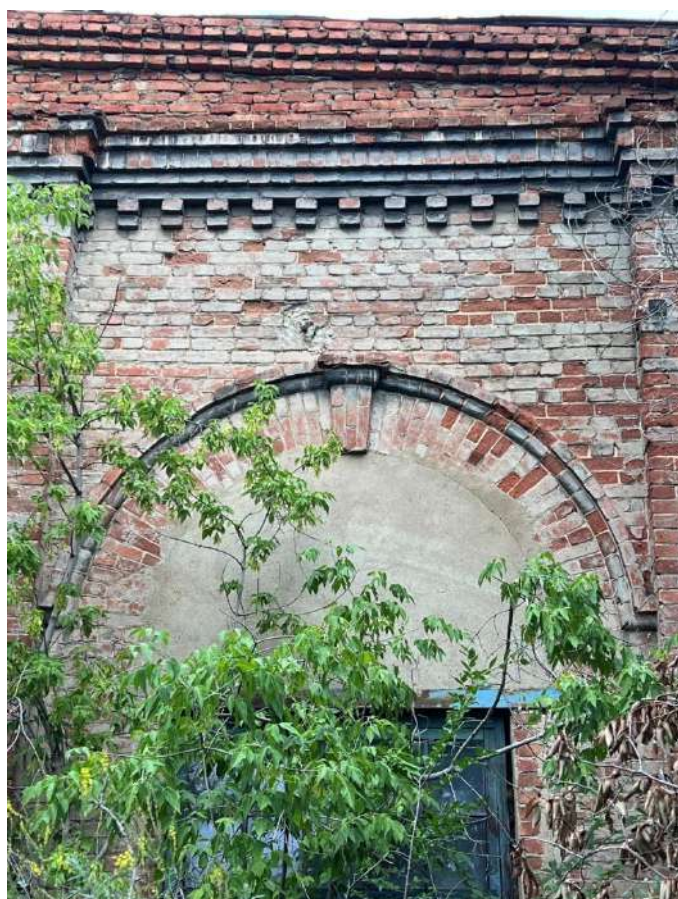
Фрагмент бокового, южного фасада. Арочная перемычка оконного проема и решение карниза
